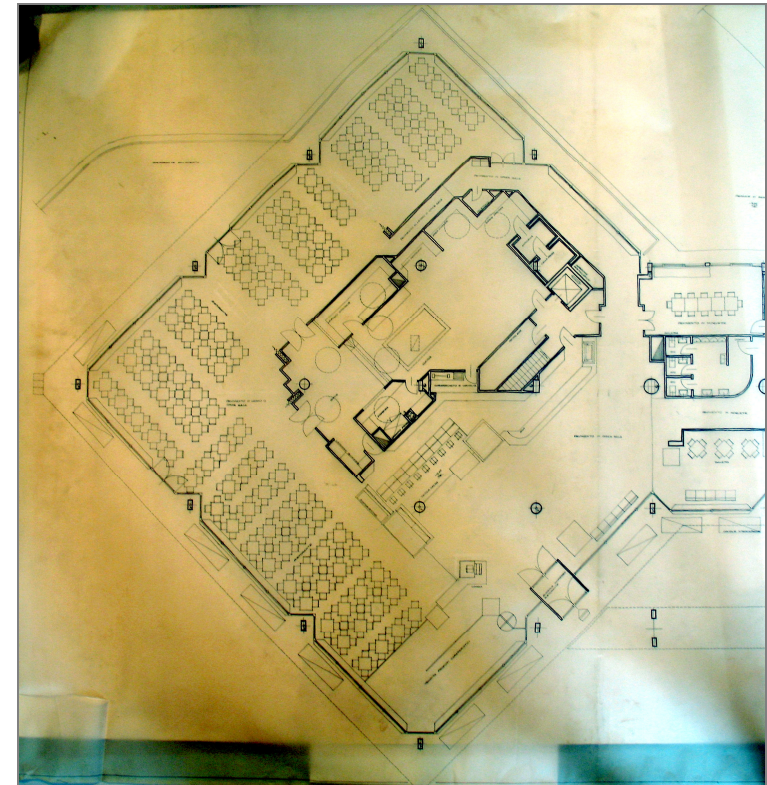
pianta piano terra corpo B (fonte CSAC – stralcio tav. 38, archivio n. 161-1)
